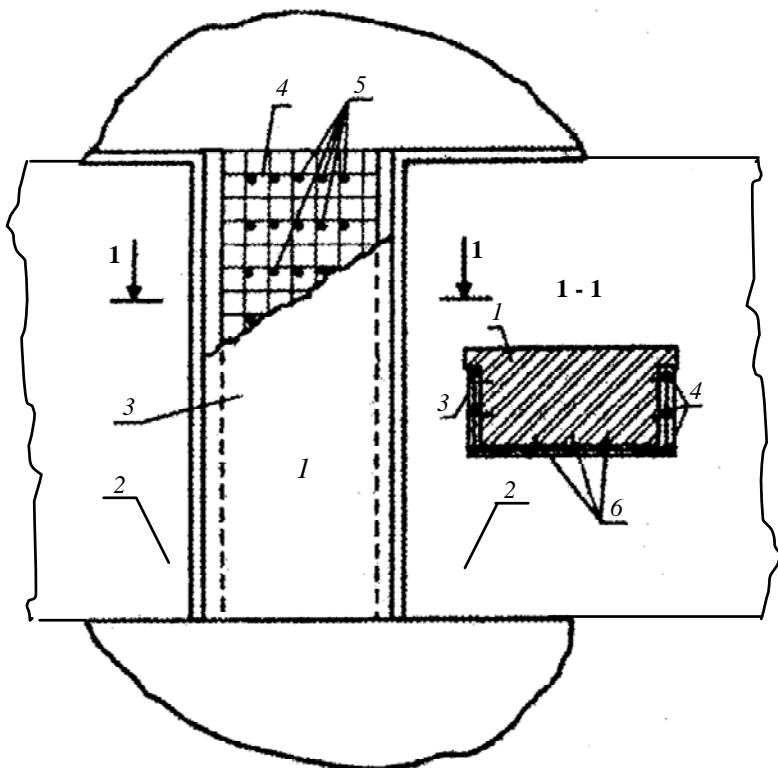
Устройство штукатурной или железобетонной рубашки:
